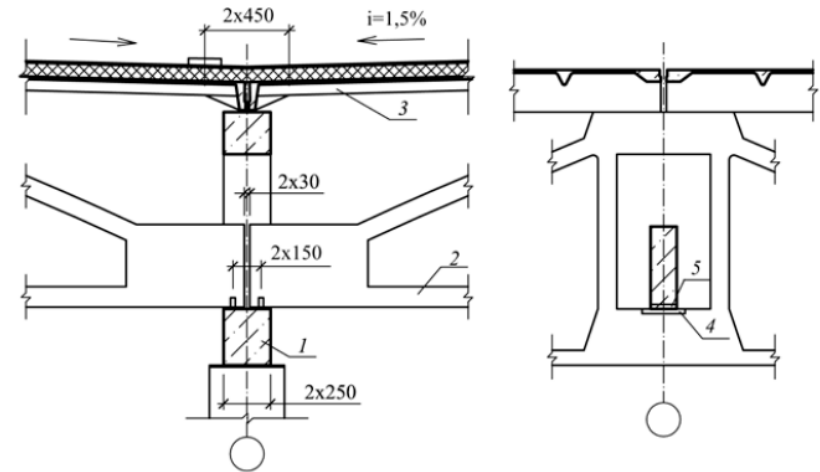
Спр'яження кроквяних ферм, підкрівляних ферм і колон:
